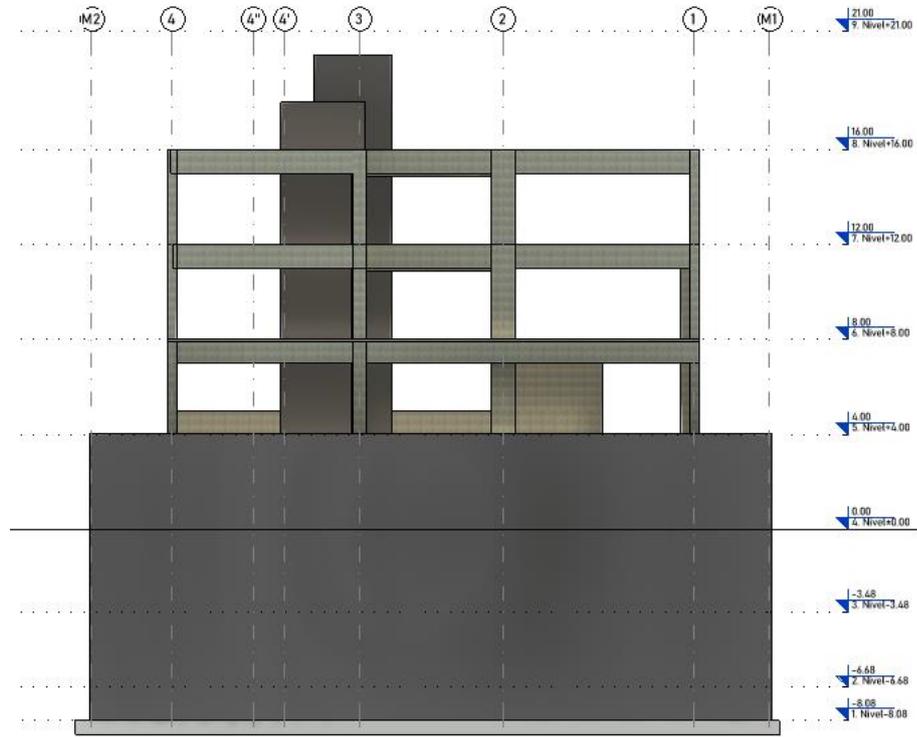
Fachada Oeste Modelo Estructural 3D. (Elaboración Propia)
